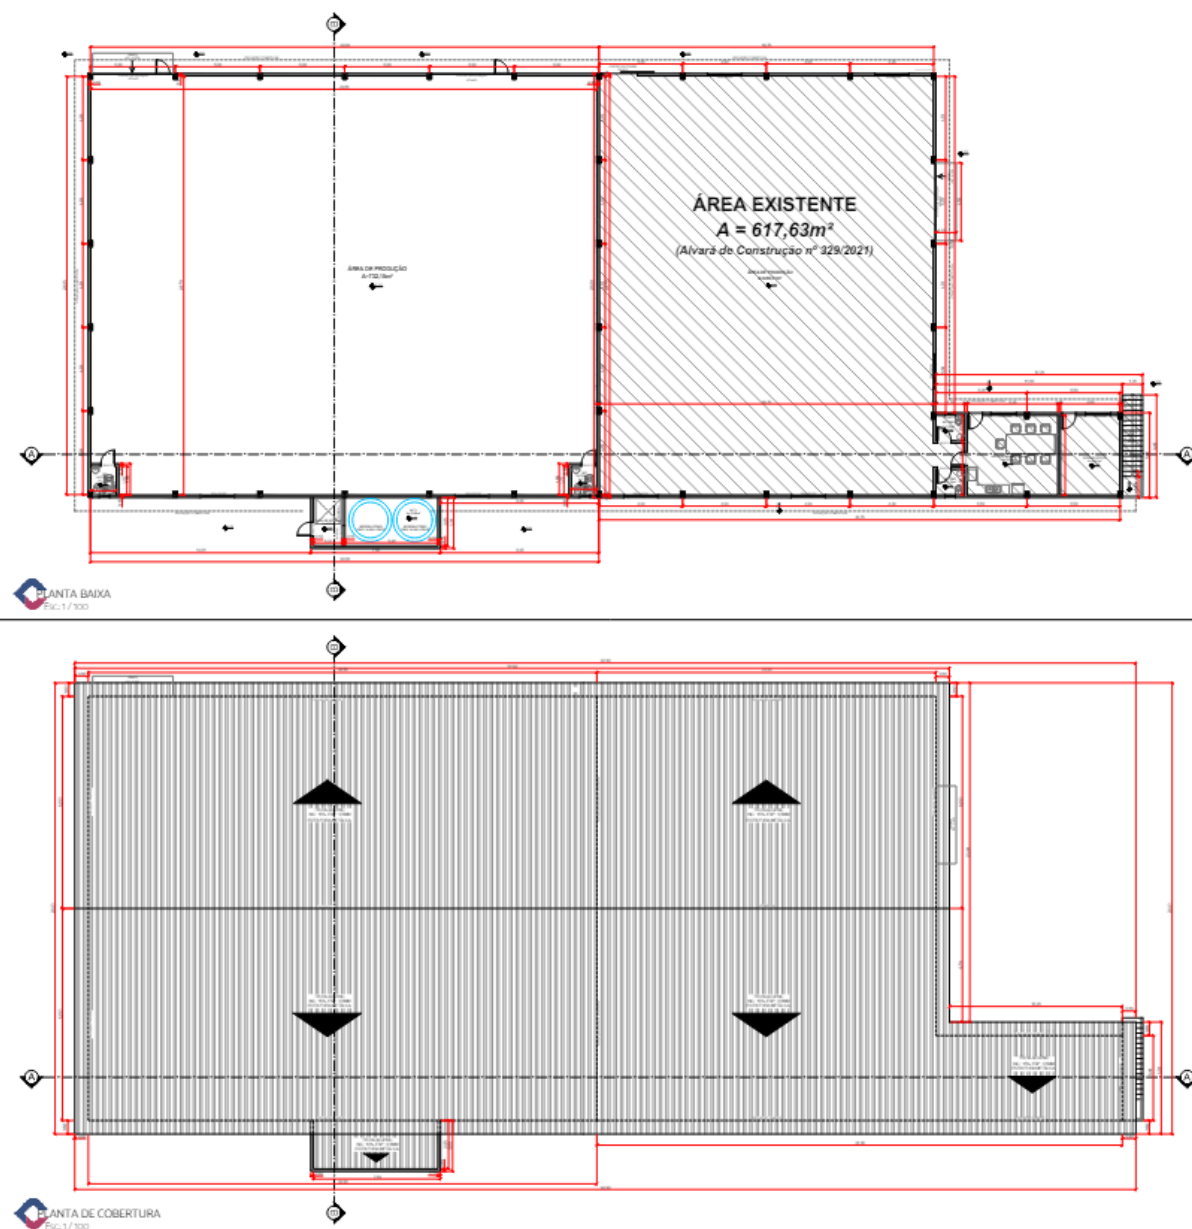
Planta baixa e planta de cobertura da edificação a ampliar.
